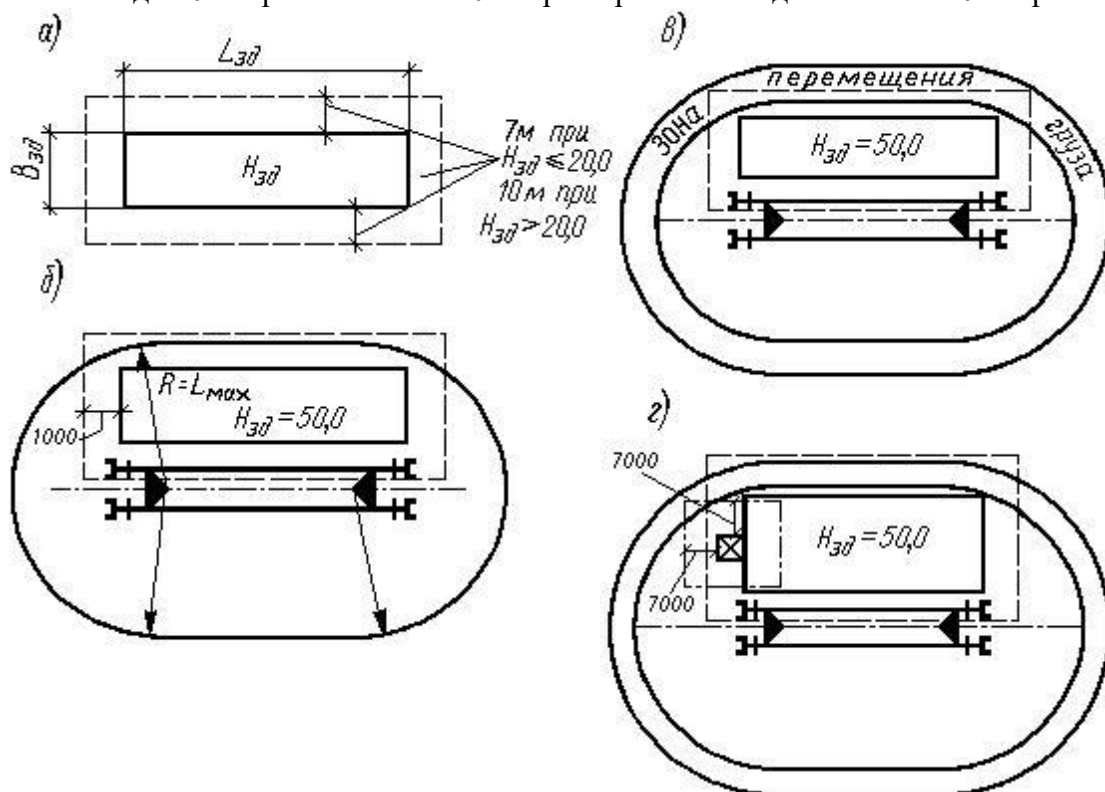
Определение необходимых зон при возведении надземной части зданий башенным или рельсовым стреловым краном:
